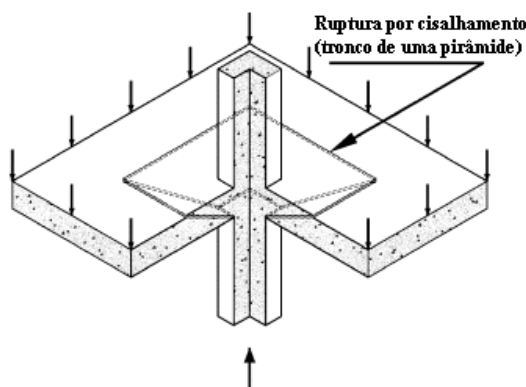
Configuração de ruptura por cisalhamento com pilar quadrado
